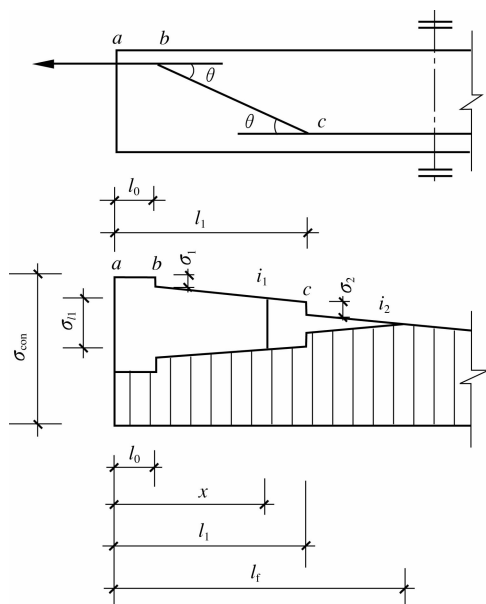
折线形预应力钢筋的预应力损失 σ_{l1}
